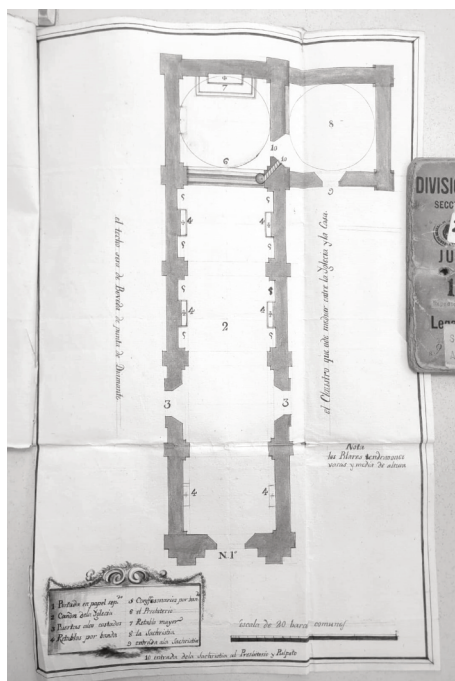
Detalle del plano original de la planta de la capilla de San Felipe Neri (Sucre).
